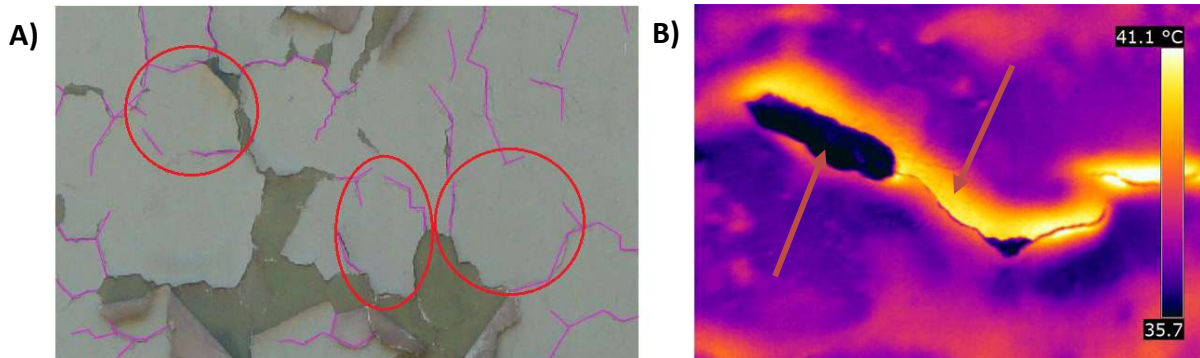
Padrões de figuras fechadas por configuração de fissuras em magenta (“A”) e termograma de uma fissura na pintura a 1m de distância (“B”).
